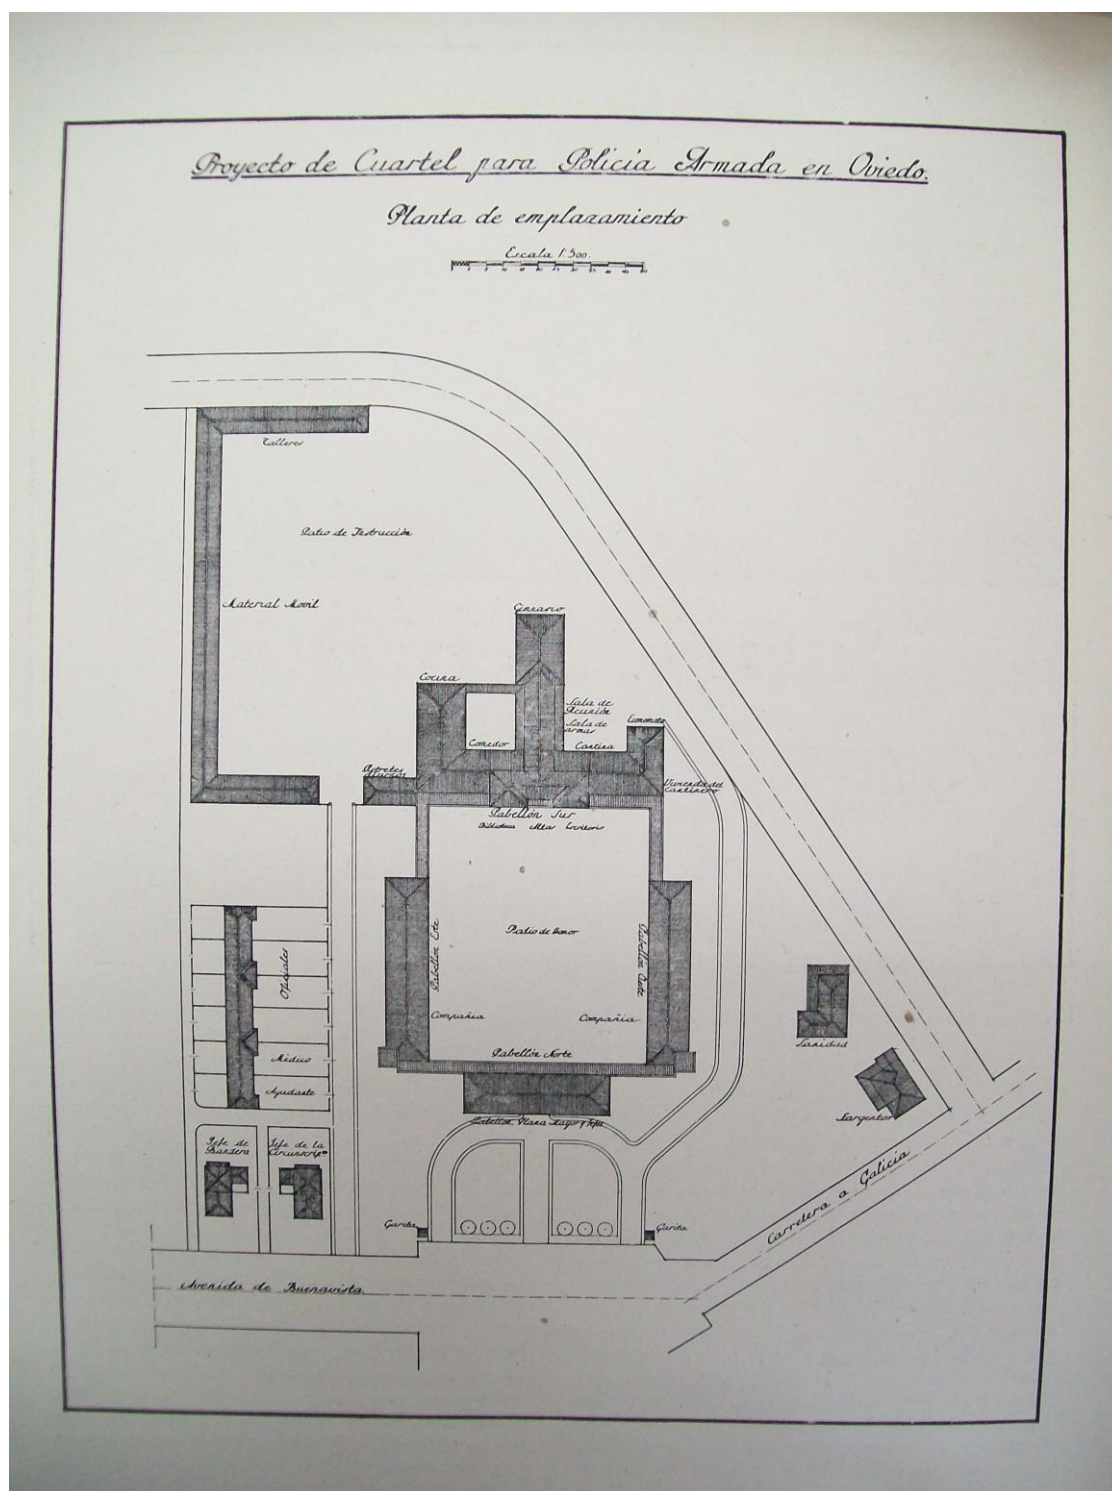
Plano de planta del proyecto de construcción de la casa cuartel para la policía armada. AGA, Exp. 76/04/1187.
